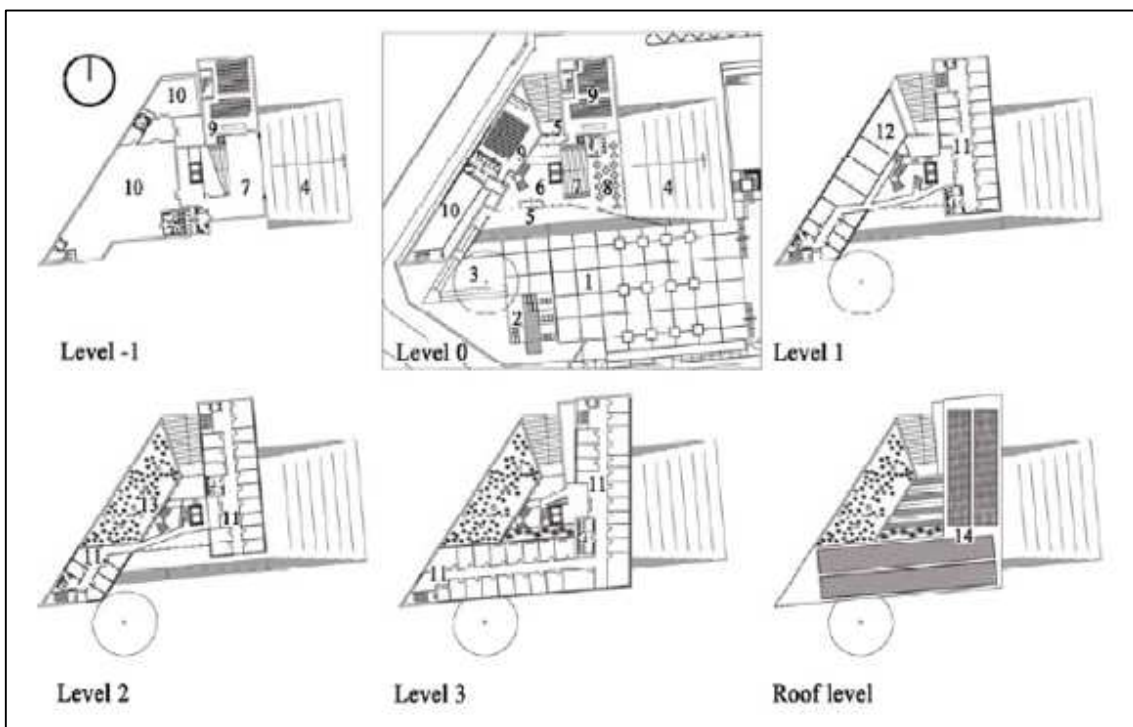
Planimetria dei piani. 1) piazza; 2) VELUXIlan; 3) alberi esistenti; 4) cavea; 5) entrata; 6) foyer; 7) auditorium; 8) bar; 9) aule; 10) NanoLab; 11) Uffici; 12) Electric Lab; 13) Giardino dei bamboo; 14) Solar Lab.
